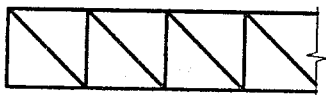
Розкісна ферма з низхідними розкосами
